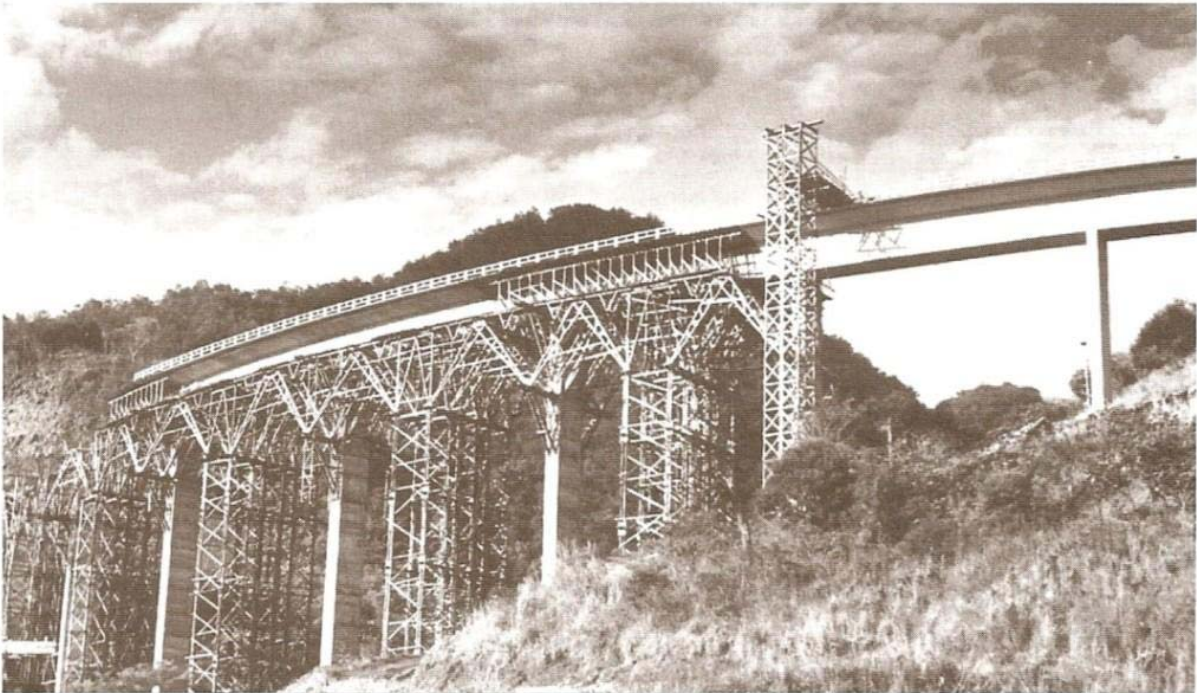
Escoramento em torres e mãos-francesas de madeira, para viaduto rodoviário em vigas contínuas de 30 m de vão. As torres mais altas do escoramento têm 40 m. As torres foram executadas com madeira roliça e as mãos-francesas com madeira serrada. Viaduto sobre o Vale dos Diabos, BR-168/RS (1960). Projeto estrutural do eng^o Walter Pfeil. Projeto do escoramento: eng.^o Viktor Boehm. Firma executora: ESBEL. Fonte: PFEIL (2003).
